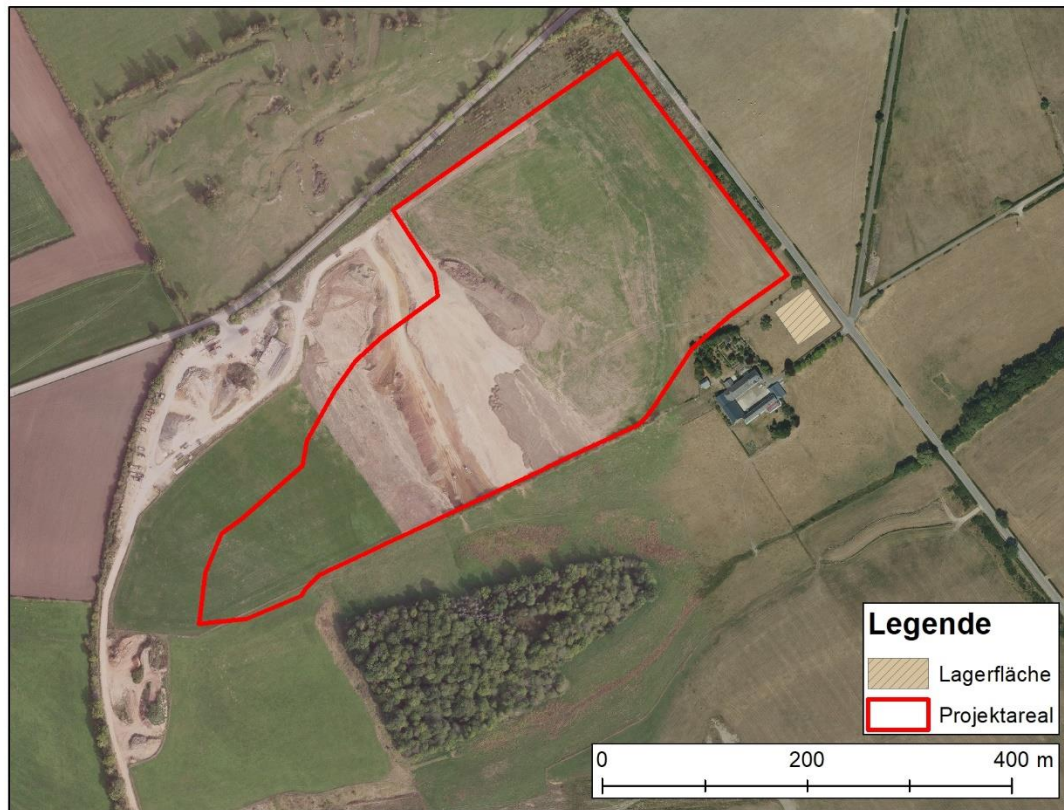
Lageplan mit Baustelleneinrichtungsfläche (3).
